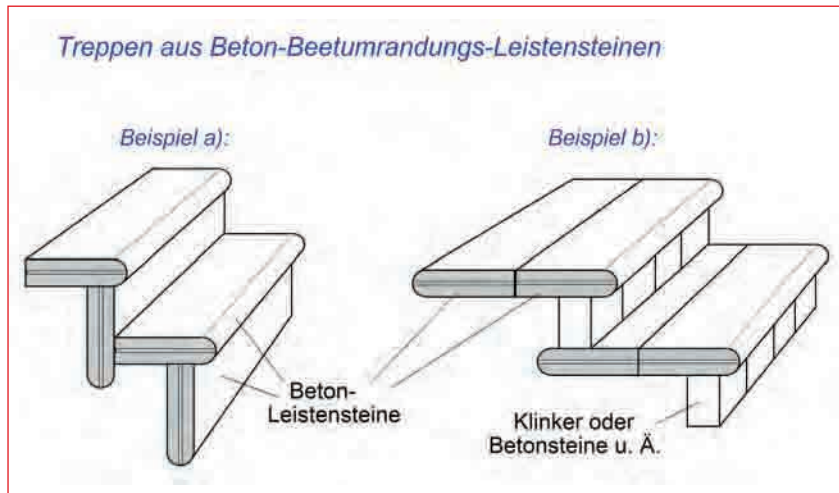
Einfach und kostengünstig lassen sich die Stufen der Gartentreppe mit Beton-Beetumrandungsleisten erstellen.
